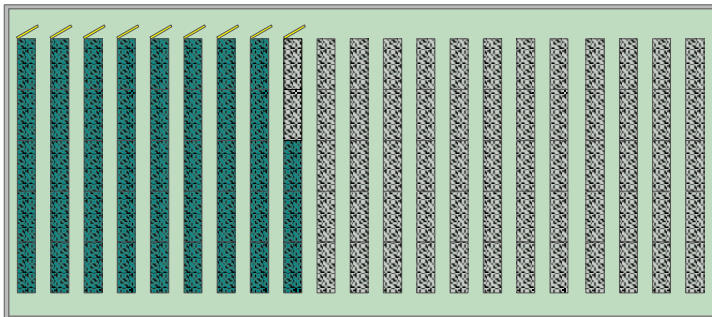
Dachaufsicht mit PV-Anlage | EG 40EE (grün) und optionale Flächen (grau)
